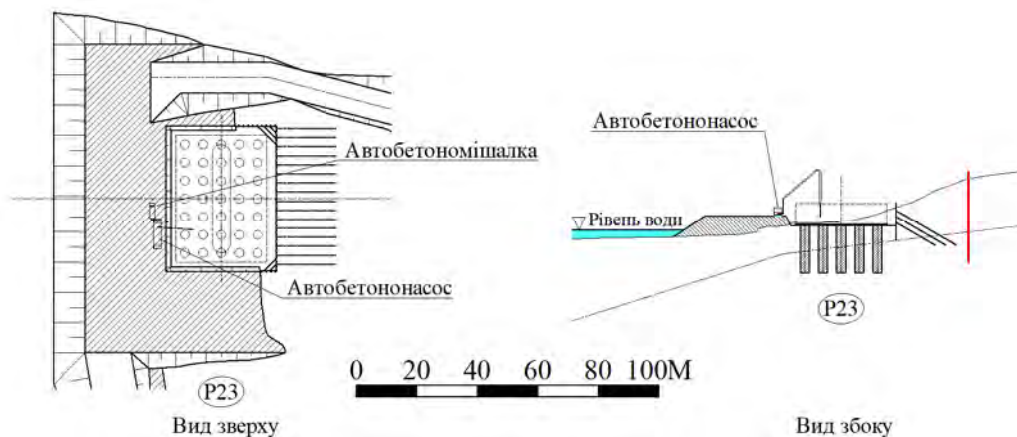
Довідкове креслення для зведення фундаменту (розміщення бетону)
